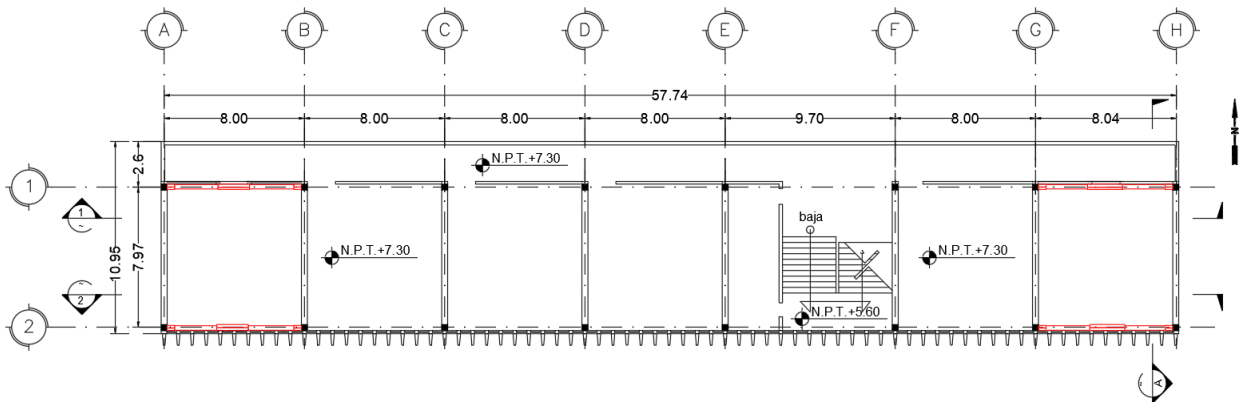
Planta primer y segundo nivel Edificio ING-4
